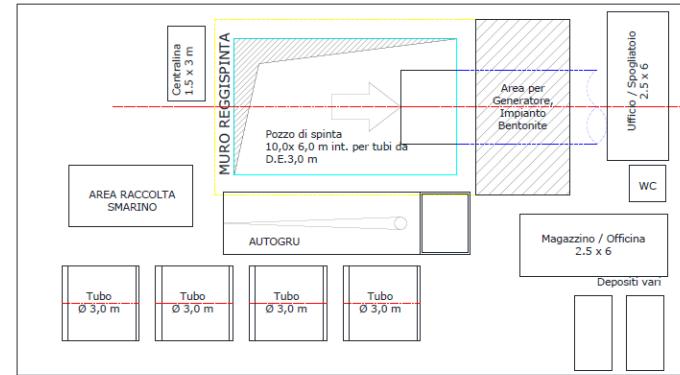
Schema di cantiere (20m x 30m) Scudo direzionale aperto DN 3000mm
